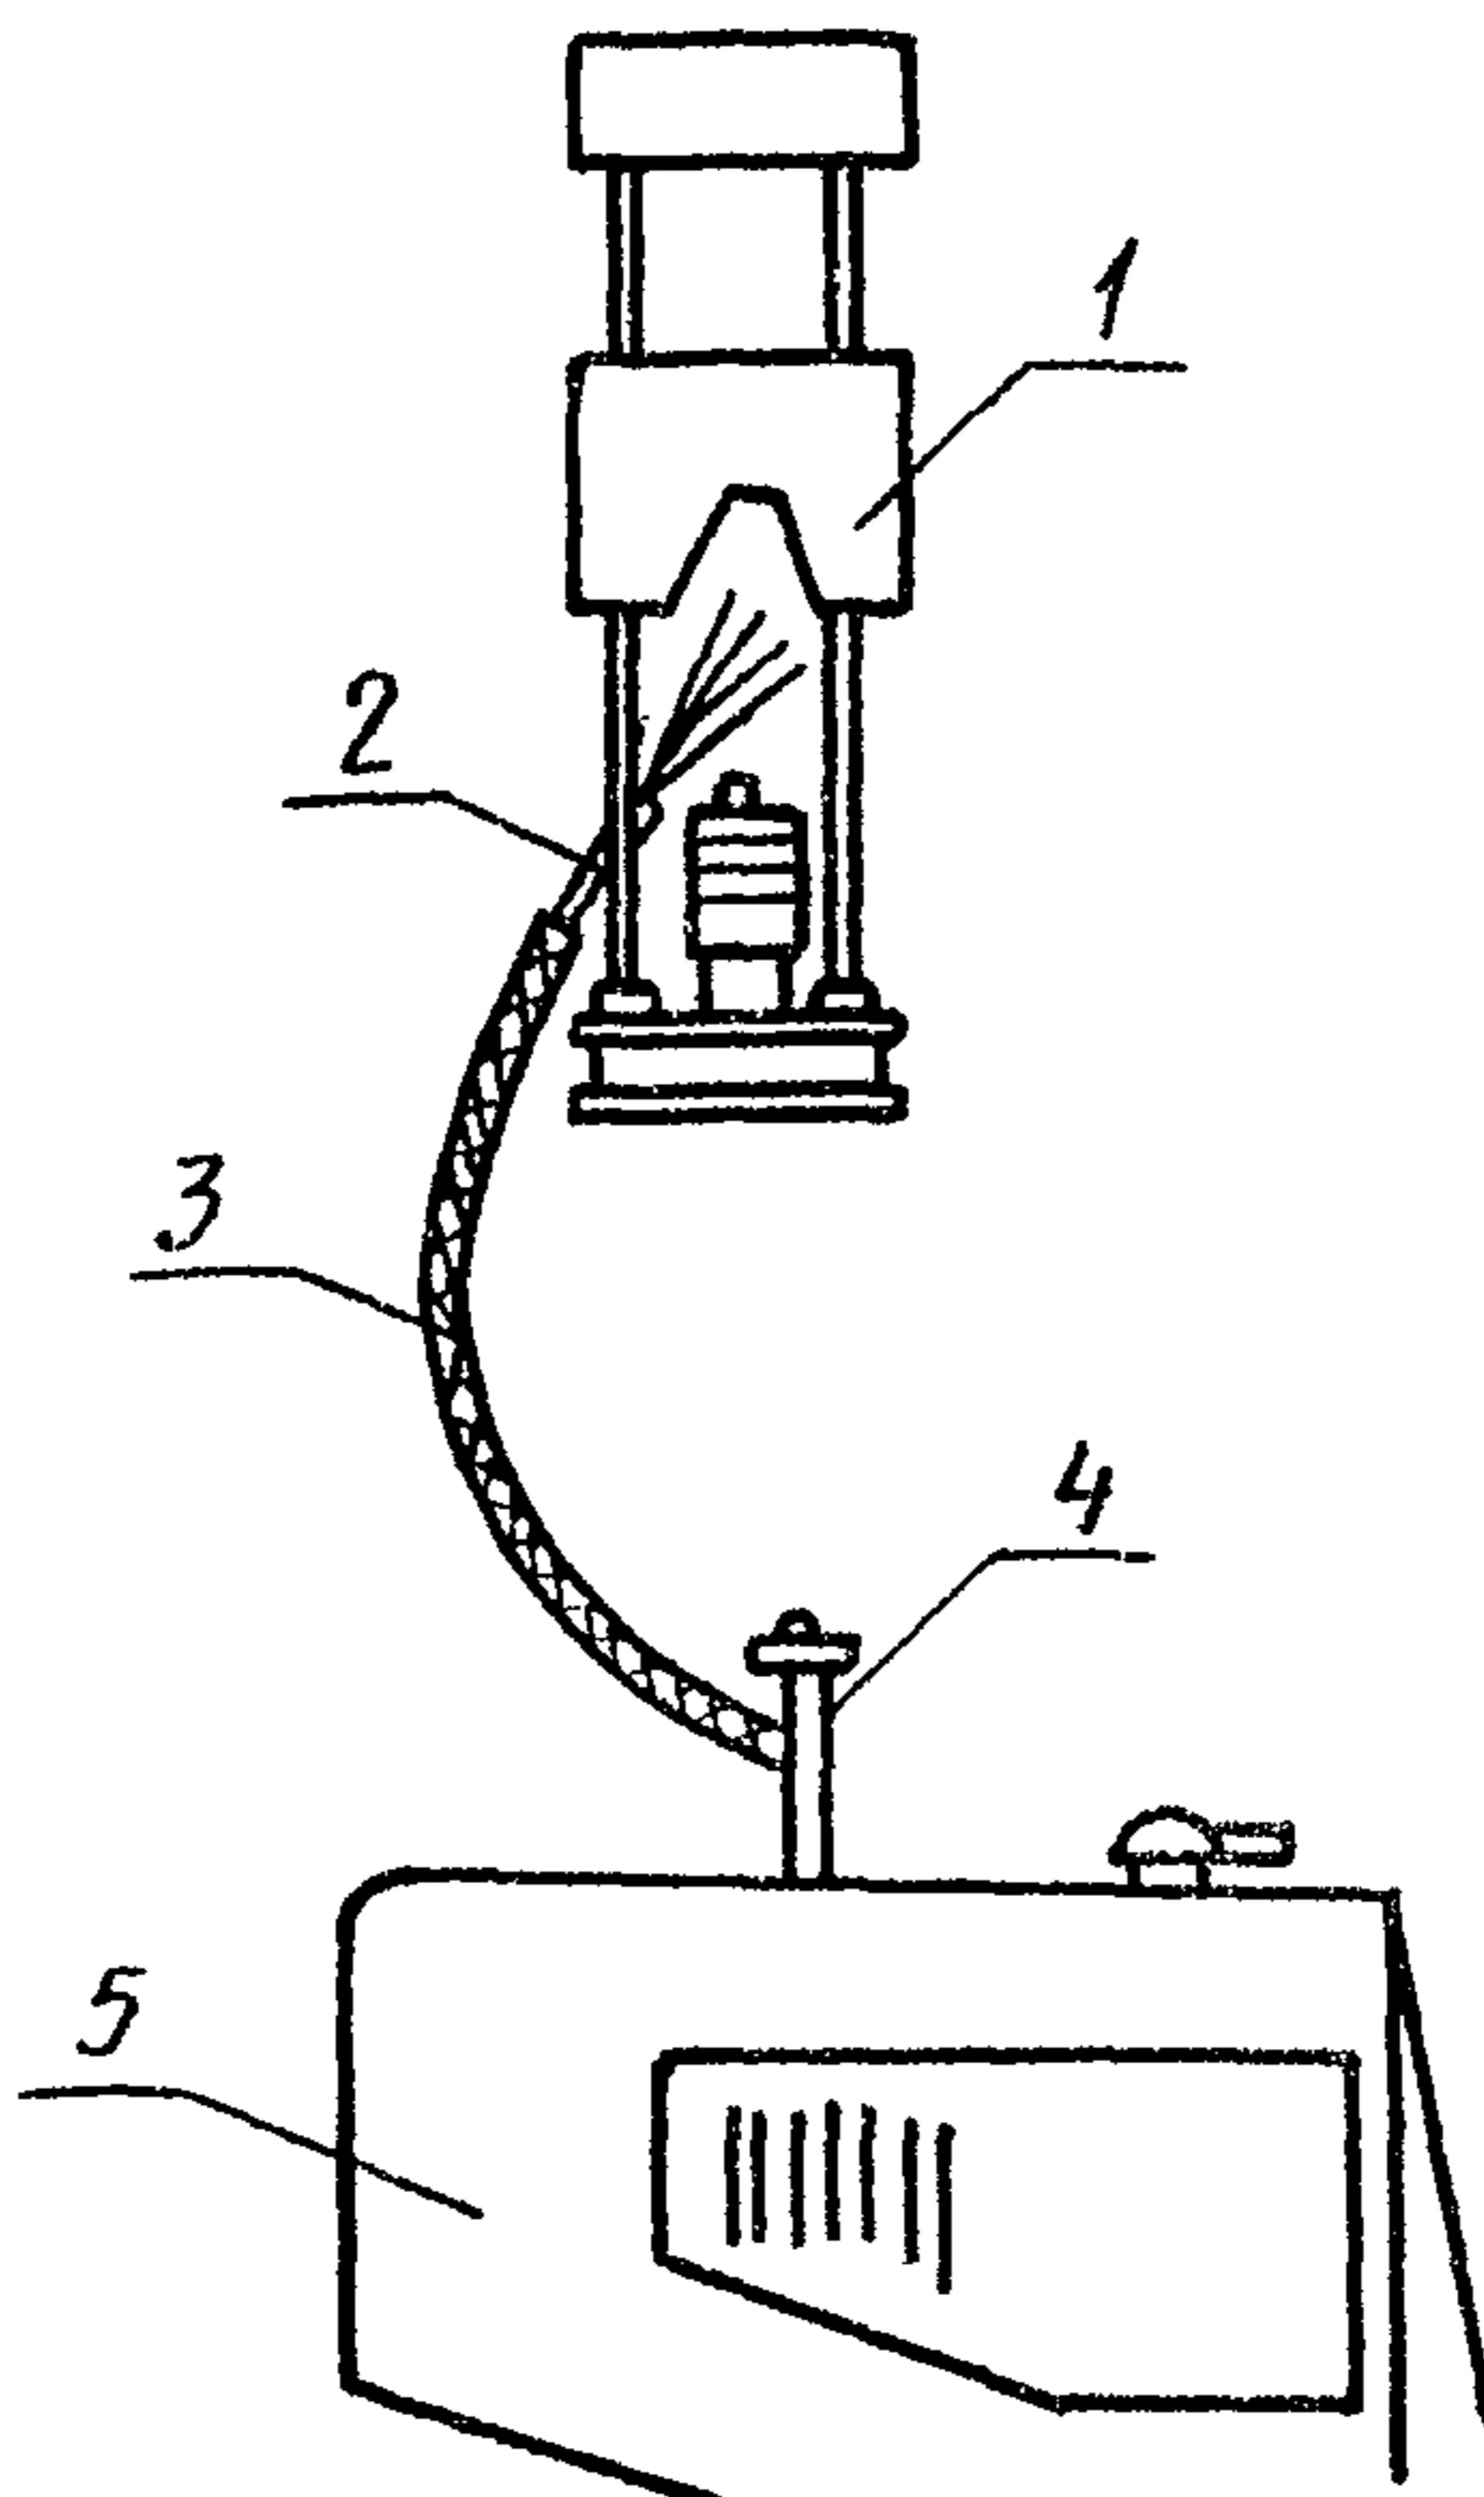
Схема принудительной продувки дизель-молота: 1-дизель-молот; 2-сопло подачи выхлопных газов; 3-гибкий шланг; 4-выхлопная труба сваебойного агрегата; 5-сваебойный агрегат
